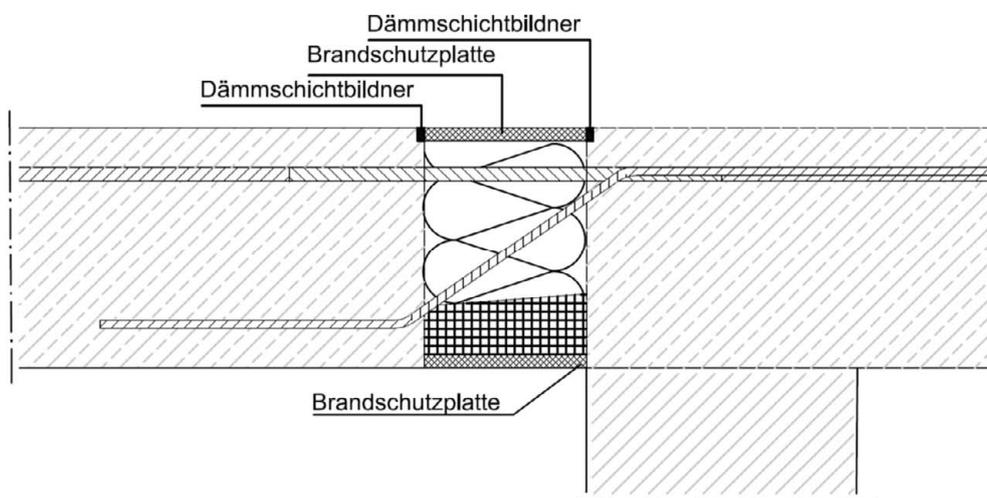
prinzipielle Ausführung mit freiliegender Fuge
